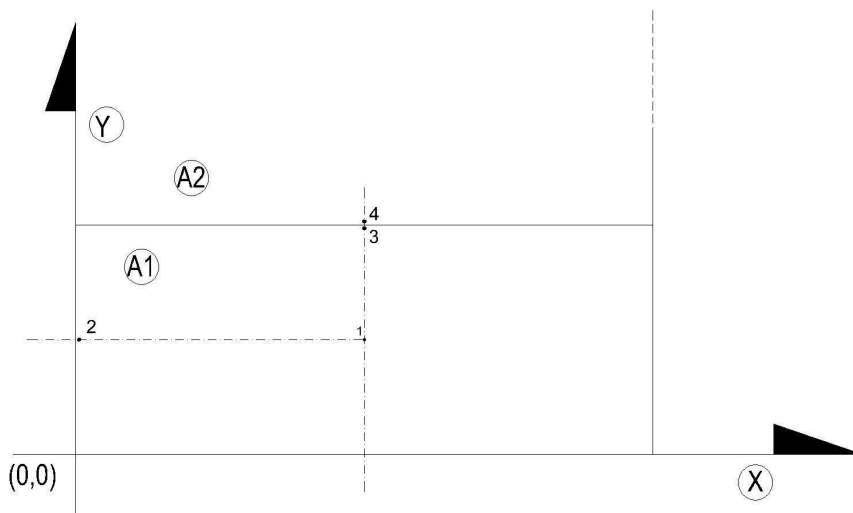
vasca di restituzione: planimetria direttrici di calcolo
